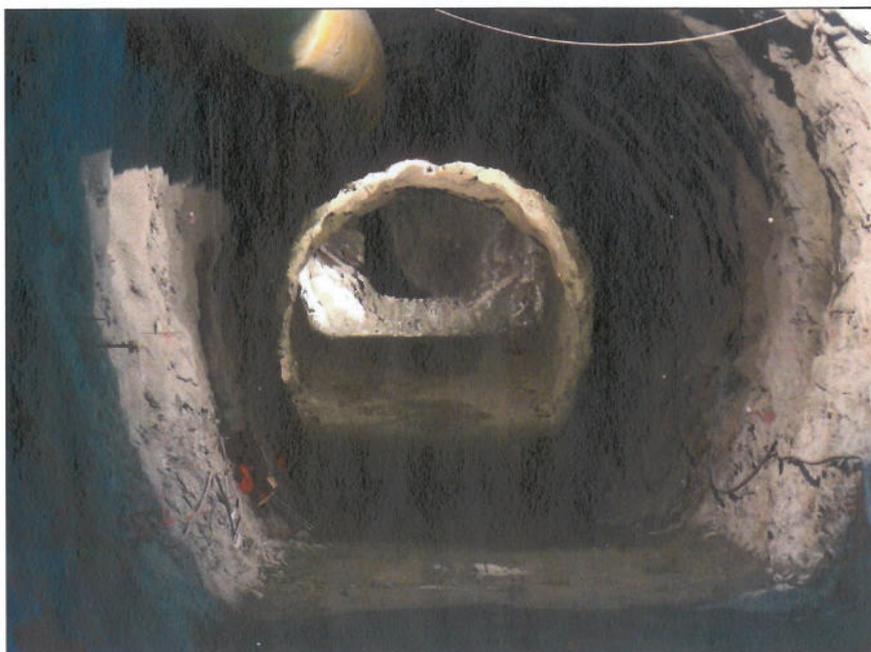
Galeria de Adução 1 – Vista da galeria de ataque em direcção ao poço
